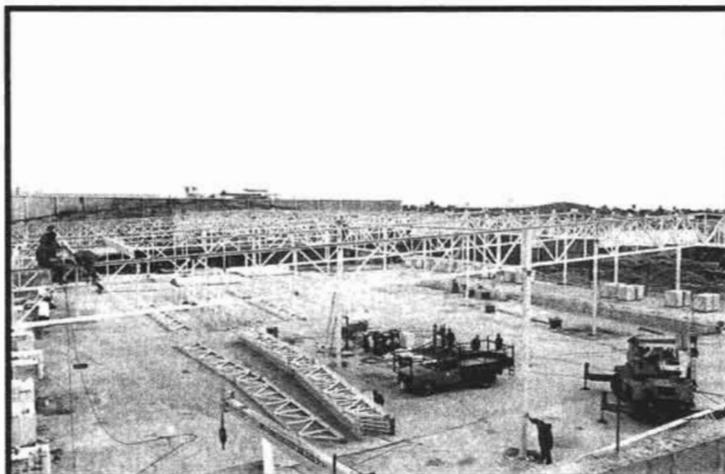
Figura II.I Vista de la construcción de una nave industrial a base de estructura metálica
